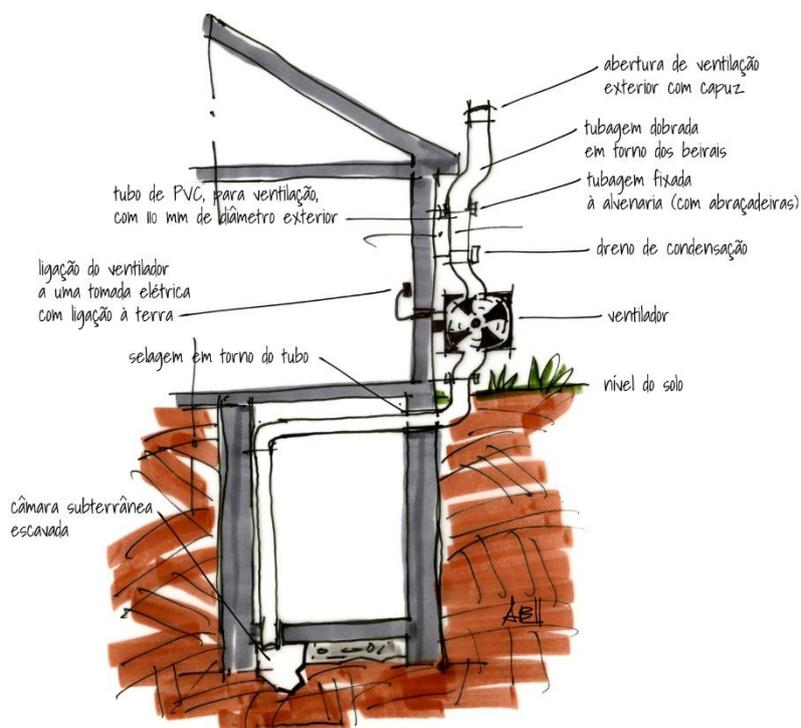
Exemplo de sistema de câmara subterrânea instalada sob o pavimento de uma cave, com condutas e ventilador localizados no exterior
